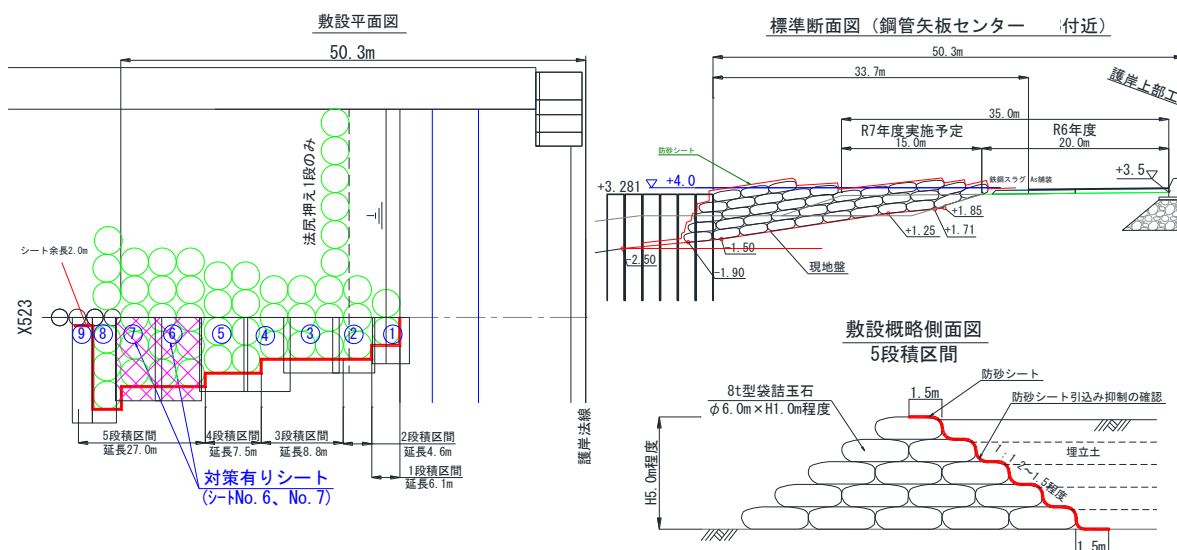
本工法のシート箇所敷設平面図と概略断面・側面図
